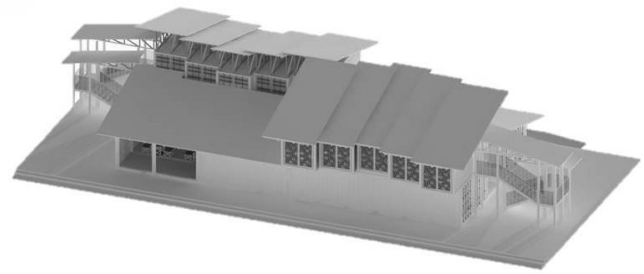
Aksonometri Struktur Bangunan Hostel
